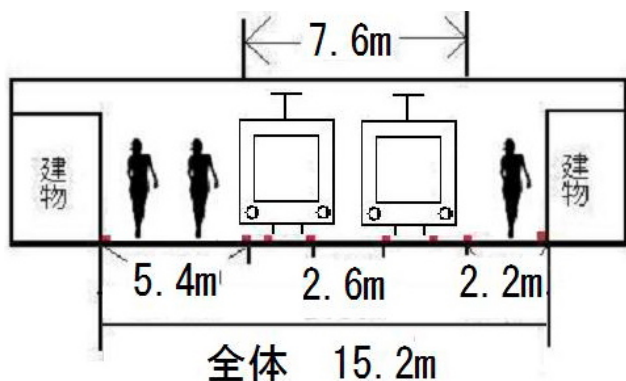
マグローヌ通り(モンペリエ, 仏)の断面図
